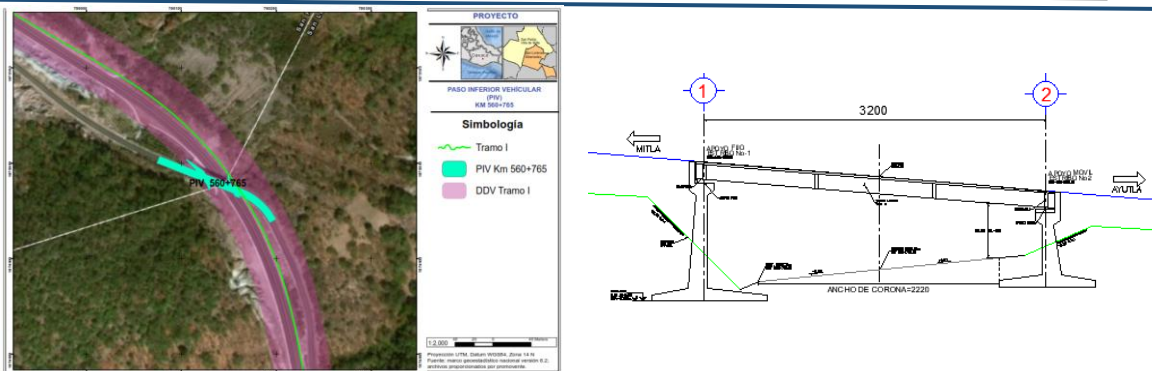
Proyecto en planta y perfil longitudinal del PIV 560+765.
